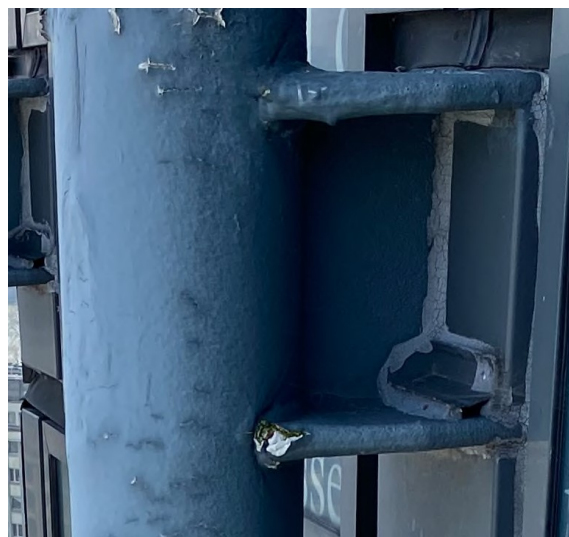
R+17 cas d'un défaut de jonction entre poteau et poutre
